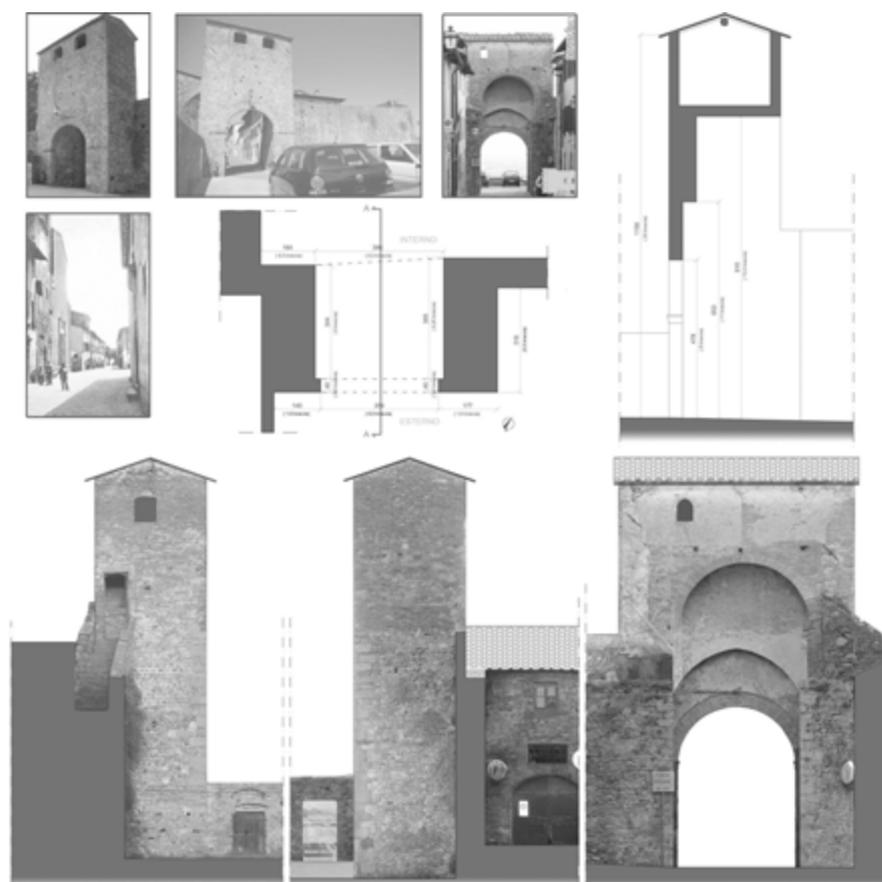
Porta Nuova: Immagini, pianta, sezione, prospetto laterale fotopiano, prospetto laterale fotopiano, prospetto interno fotopiano
